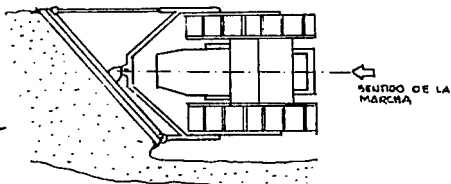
ANGLEDOZER (VISTO EN PLANTA)
